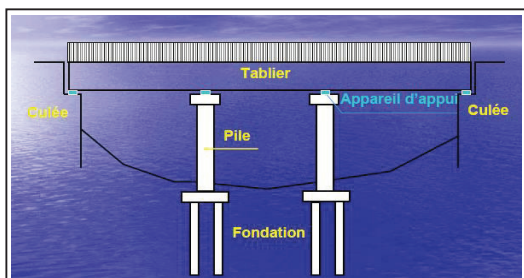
Vue longitudinale d'un pont type Figure I.2: Section transversale d'un pont à poutres
